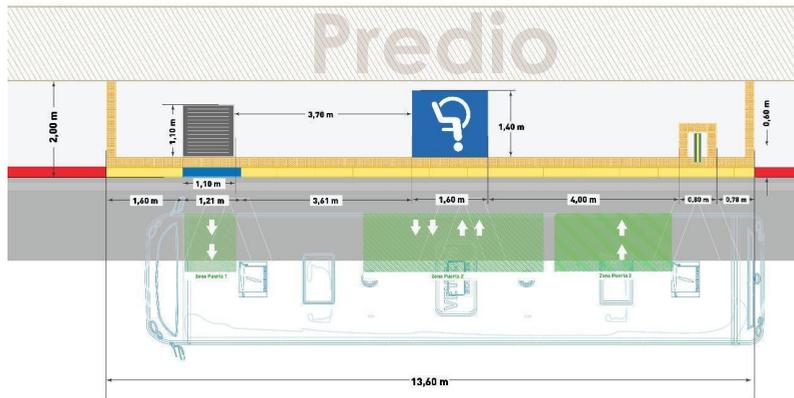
Zona paradero - caso C2; 2 - 2,99 metros * 13,60 metros - Estándar.
